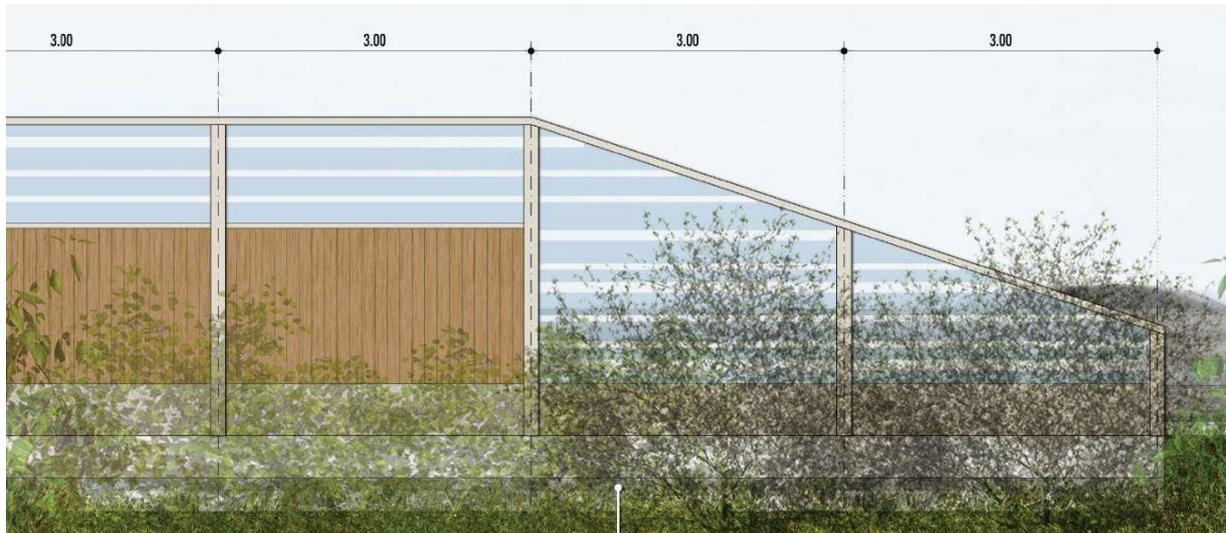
TIPOLOGICO DELLA TRANSIZIONE DI INIZIO/FINE BARRIERA - PROSPETTO SU RILEVATO, LATO RICETTORE
